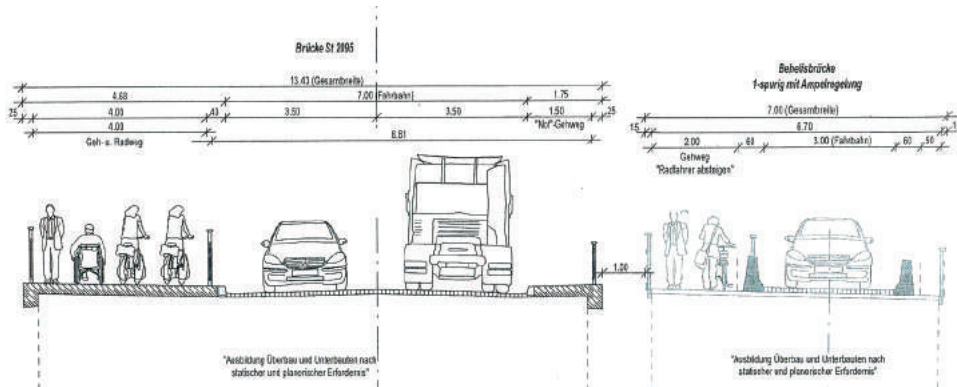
Entwurf für mögliche Ausführung bei Variante 0 - Neue Brücke in Bestandslage
